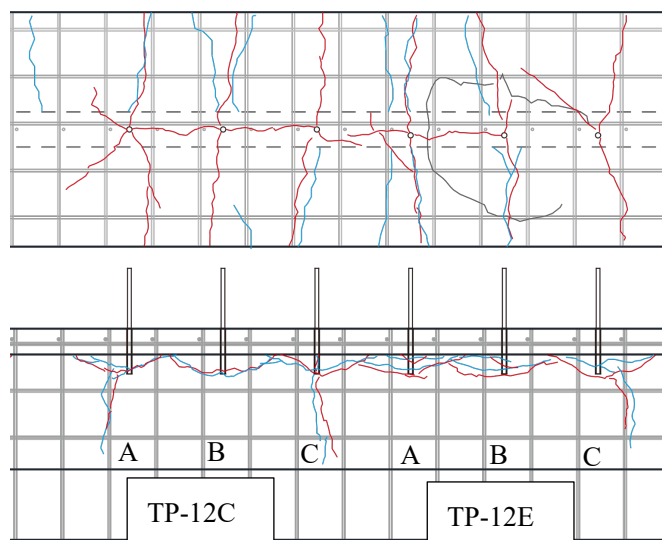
ひび割れ図 (TP-12C シリーズ, TP-12E シリーズ)
